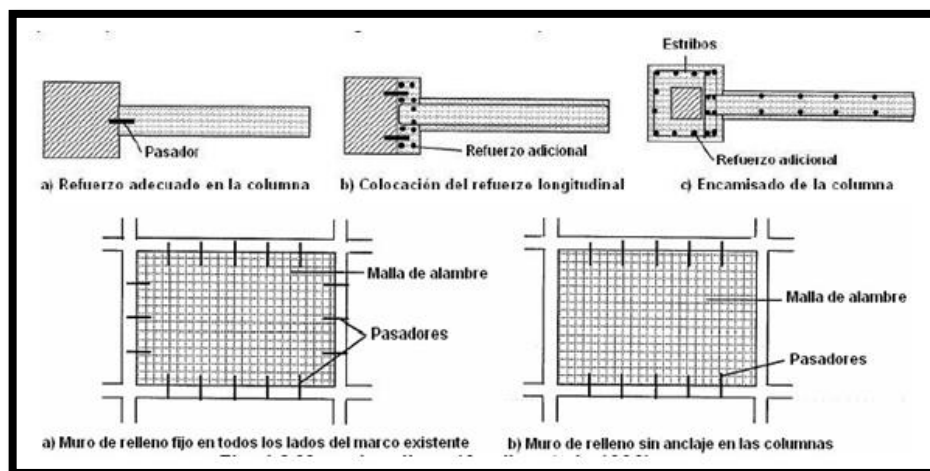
Muro de relleno y Conexión de un muro de concreto (Aguilar,J.; Breña,S.; Del Valle,E.; Iglesias,J.; Picado, M.; James M., 1996)
